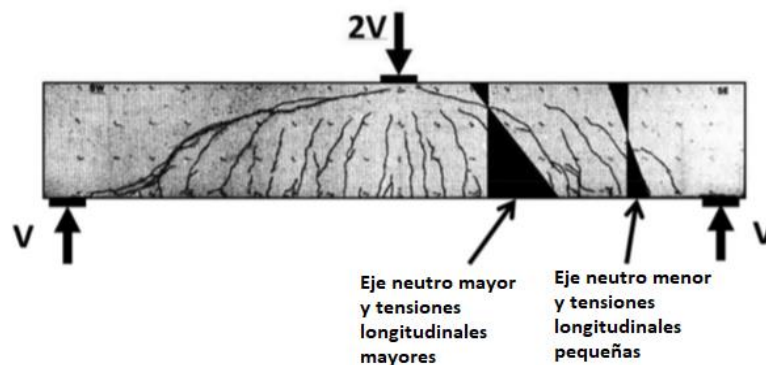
Tensiones longitudinales en dos secciones transversales en viga de H.A. (Kutchma et al., 2019).
